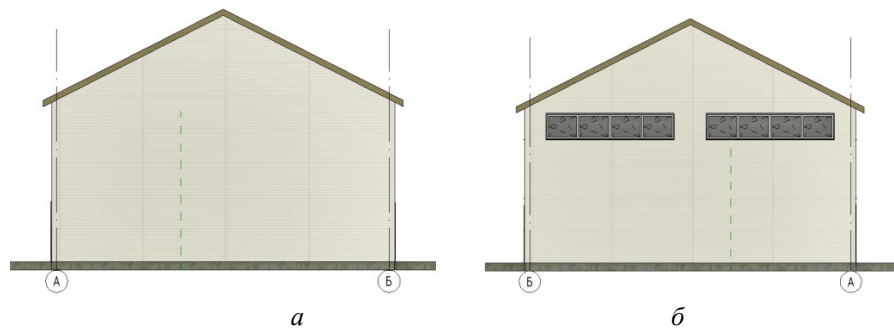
Фасады боковые: *а* — фасад А—Б; *б* — фасад Б—А
